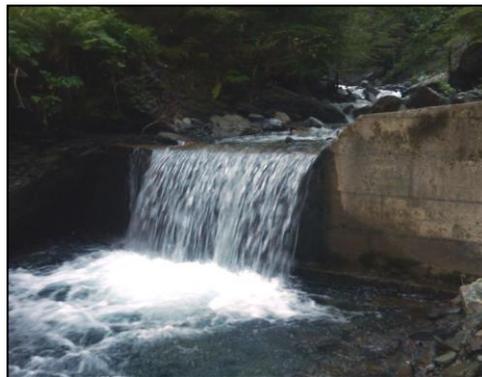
seuil sur la Pique (31) sans passage au travers ni voie de contournement © F. Blanc
